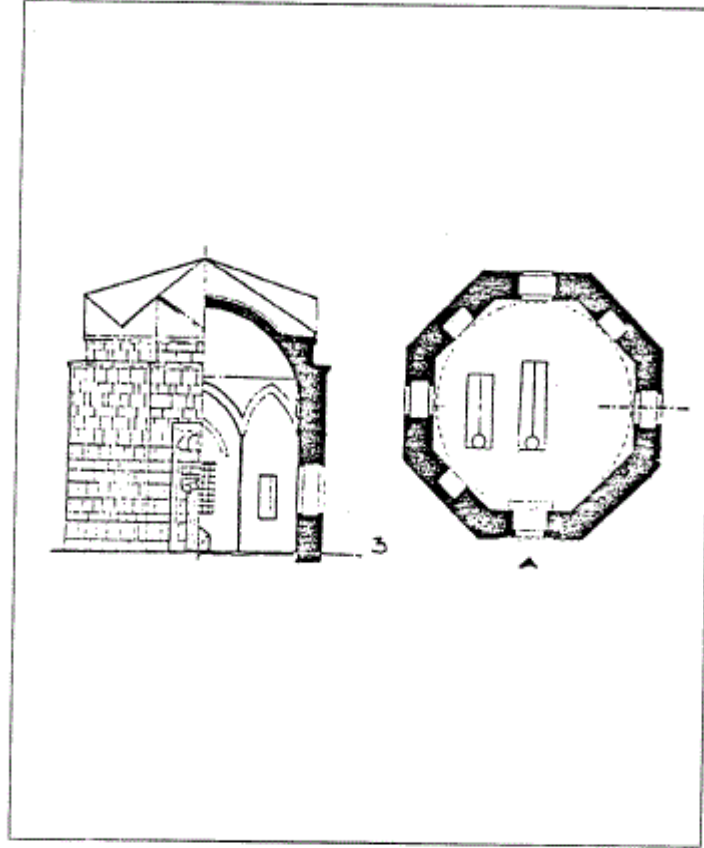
مسقط أفقي لثروة سليم الأول بإستانبول (عن : اصلان ابا) .
